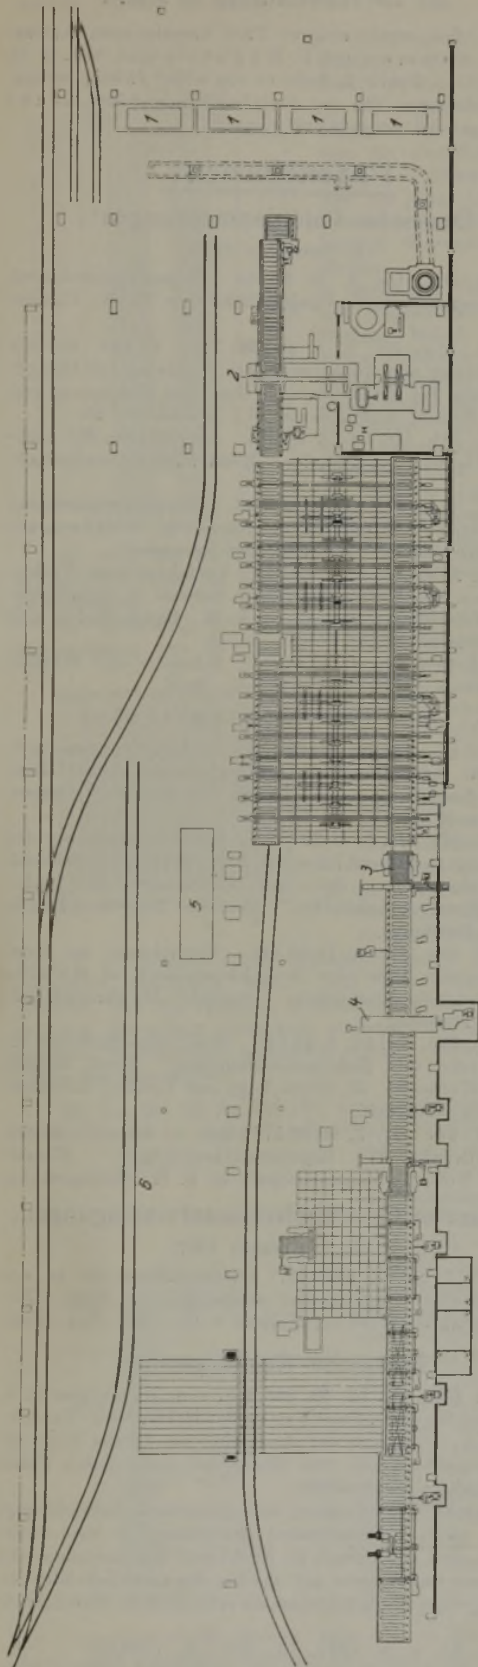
Grundriß des Blechwalzwerks der Bolckow, Vaughan and Co., Ltd.
